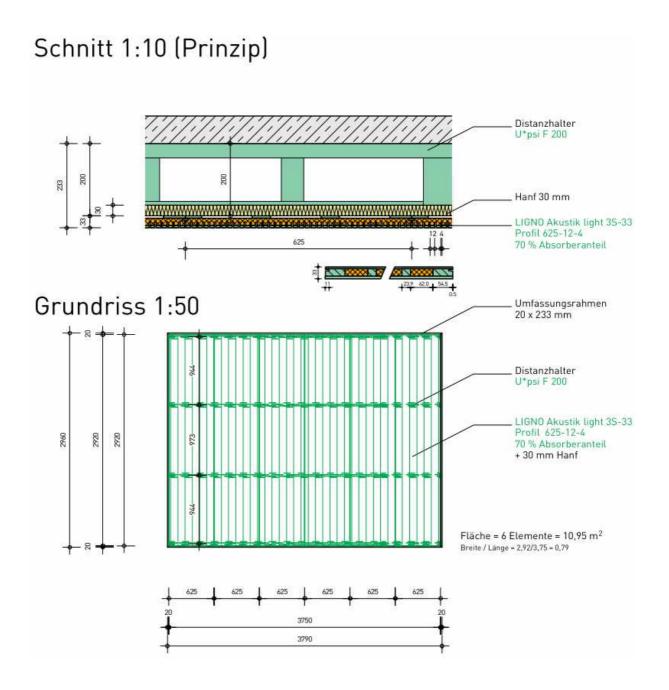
Grundriss Hallraum mit Rahmen
